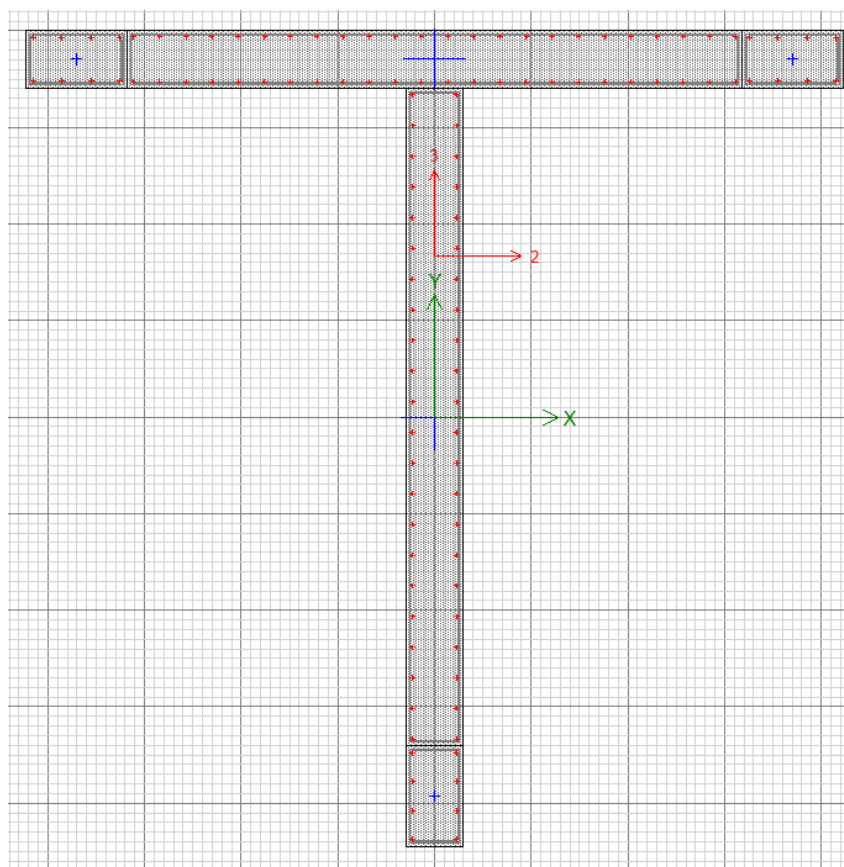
16: Modelación de muro en T de concreto reforzado en ETABS
